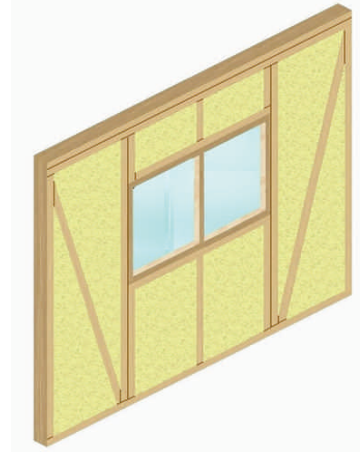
34: Colocar las ventanas mientras los tabiques se alzan.
